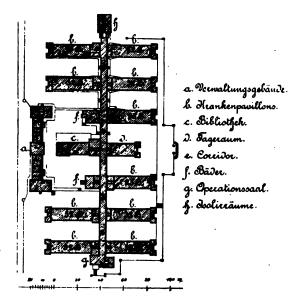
Herbert-Hospital in Woolwich. Lageplan.
